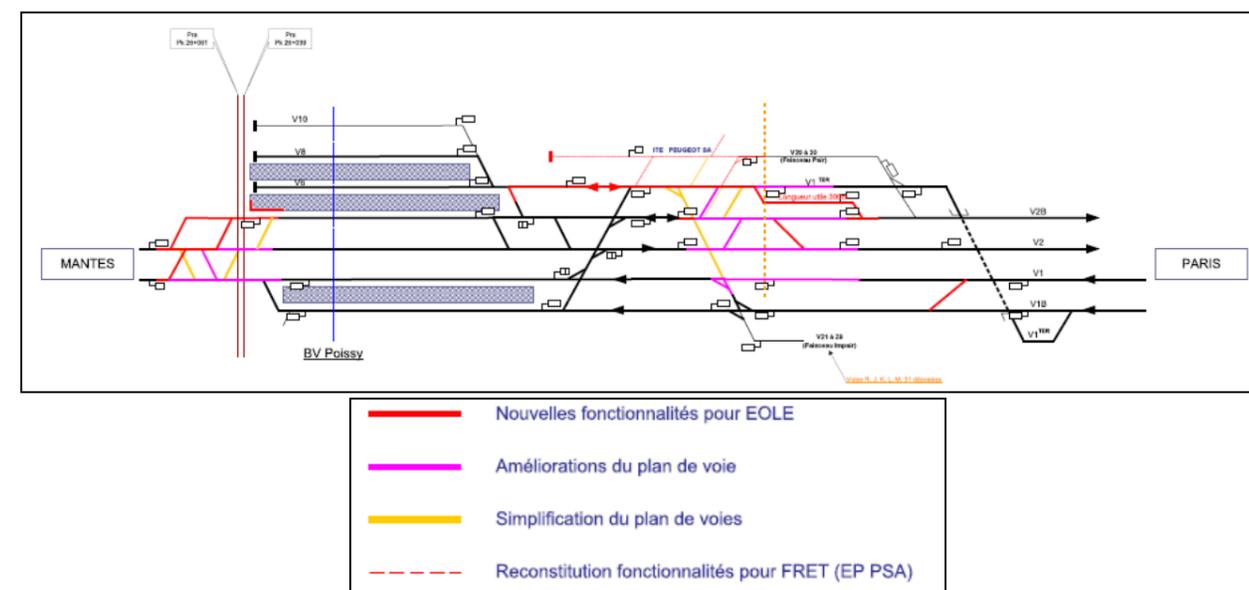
Schéma de réorganisation du plan de voies du site ferroviaire de Poissy
